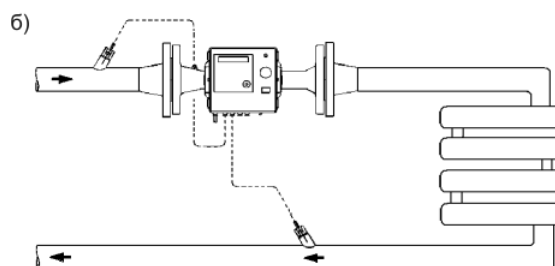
Типовые схемы установки тепломеров в тепловом узле здания на подающем трубопроводе системы отопления:
